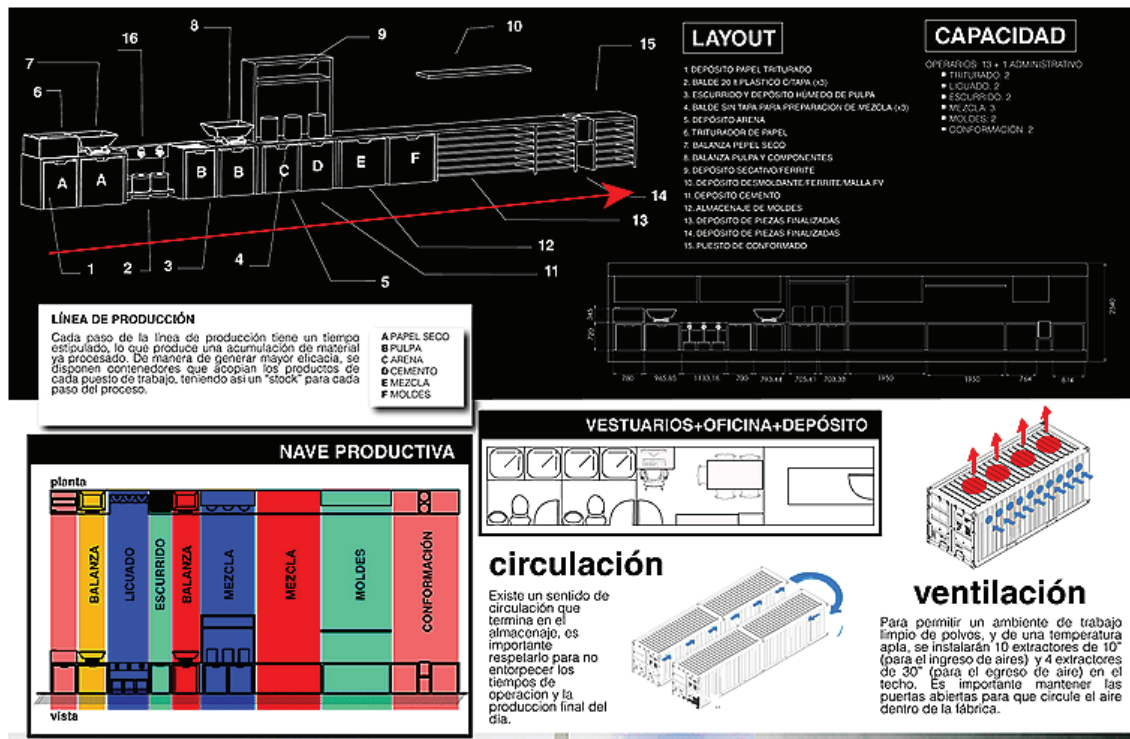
Taller Modular: Lay Out. Pasante Diseño Industrial Gonzalo Kaiser Rojo
